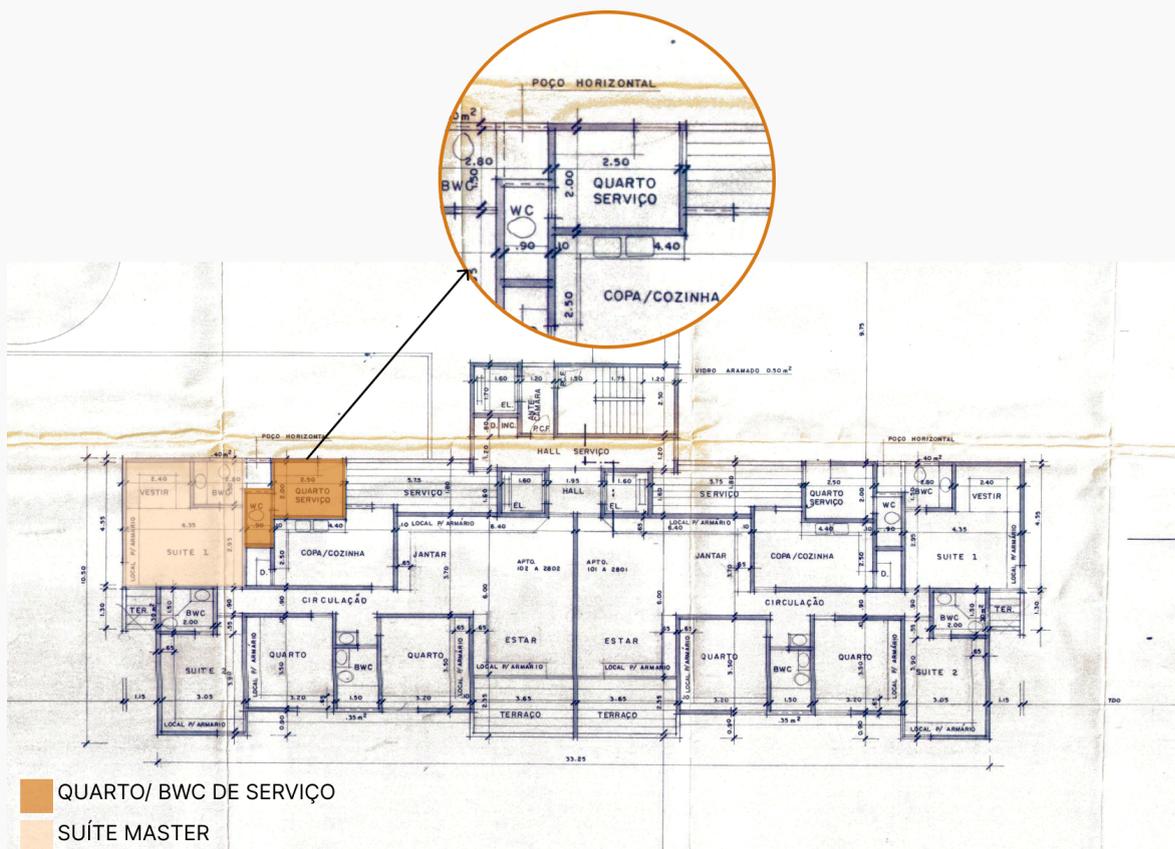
Planta Baixa ampliada do Edifício Rio Sena para análise.
